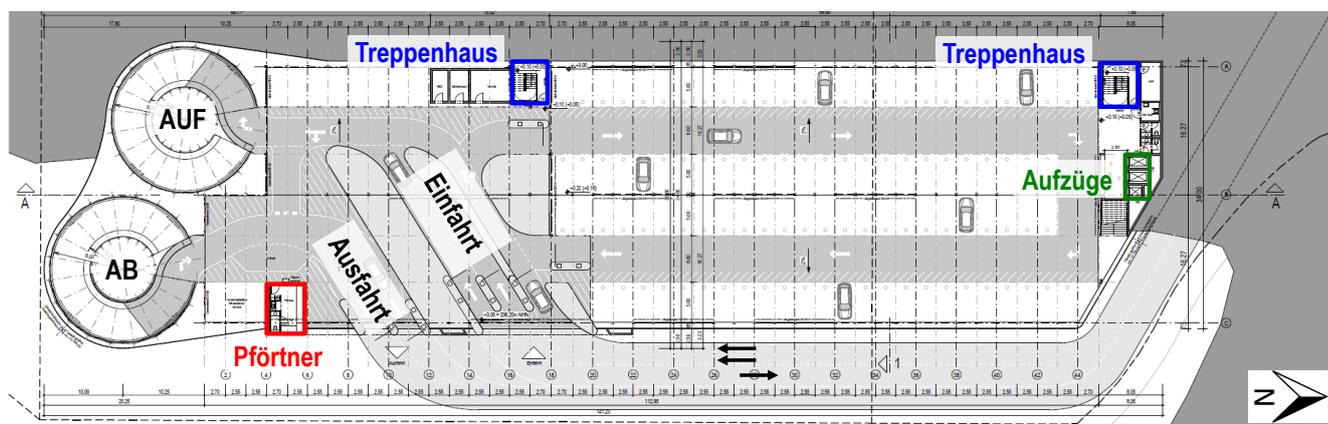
Grundrissplanung des Einfahrtsgeschosses (Quelle: fischerarchitekten)
